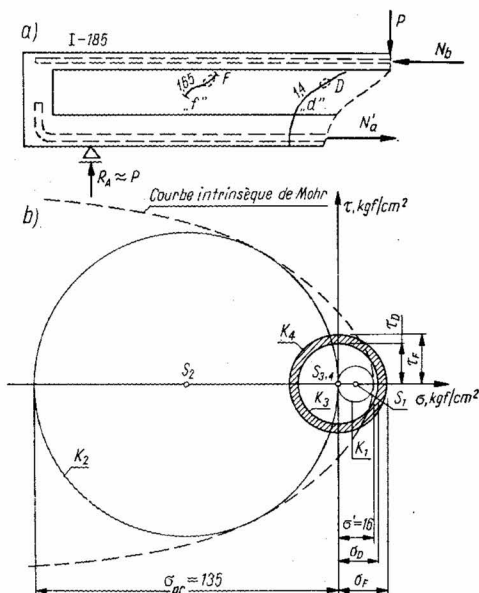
Zone d'appui de la poutre I-185 :
